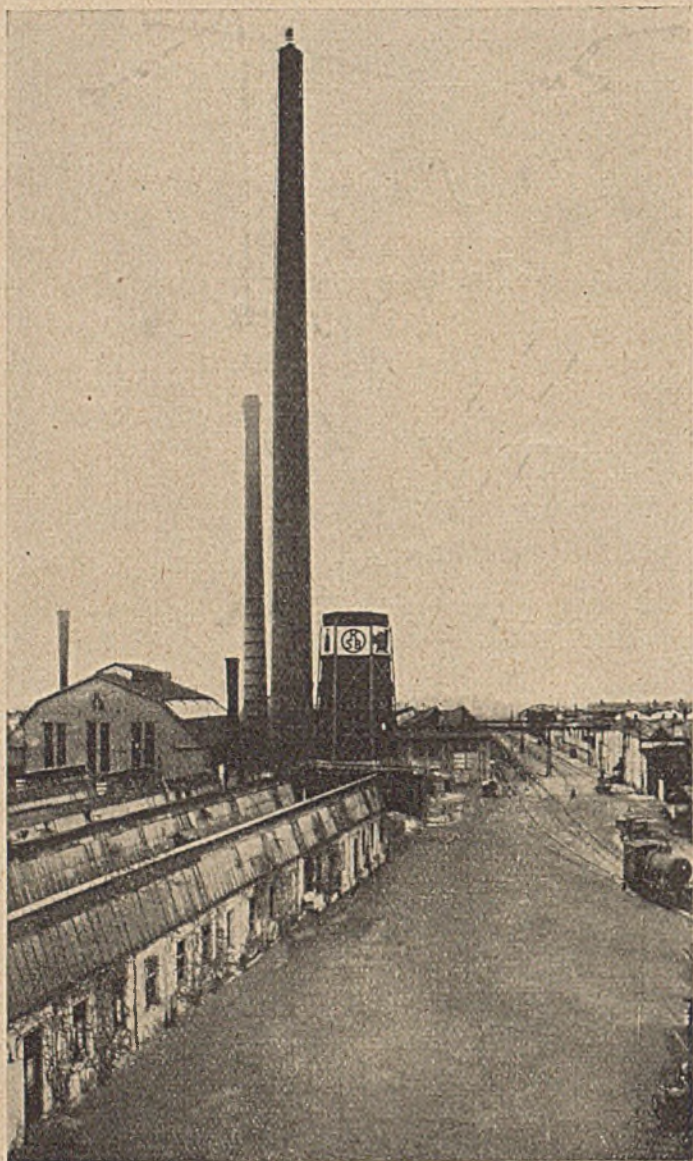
Fertiger Eisenbetonschornstein „System Lupescu“.
